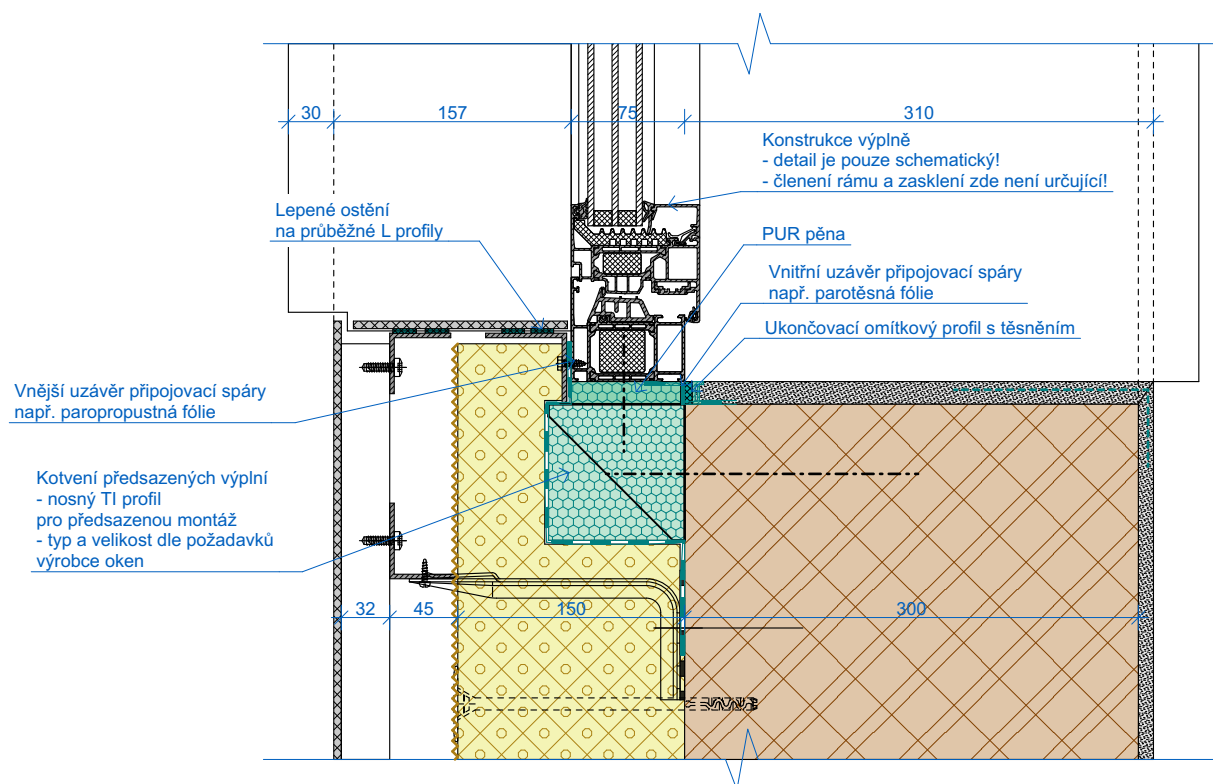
PRINCIP ŘEŠENÍ PARAPETU BĚŽNÉHO OKNA, M=1:5
